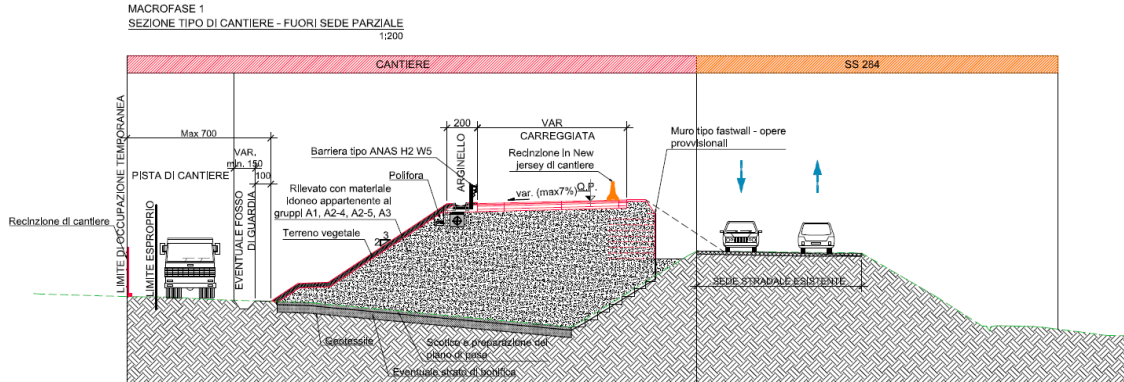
Intervento Fuori Sede Parziale (F.S.P.) -- Sezione trasversale tipologica di cantierizzazione
